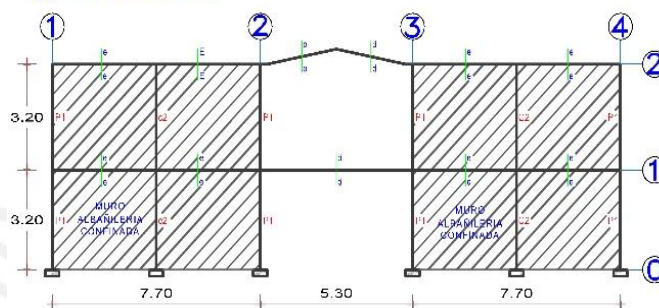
Estructura del Bloque seleccionado, planta y elevación del pórtico 1 y 4.
